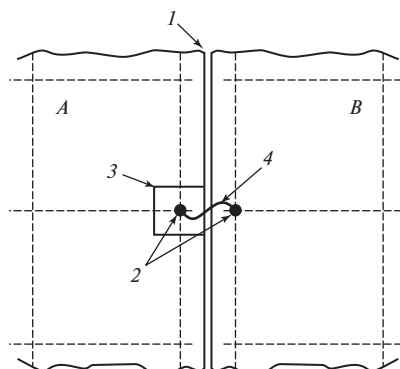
Конструкция гибкой связи между железобетонными плитами:
